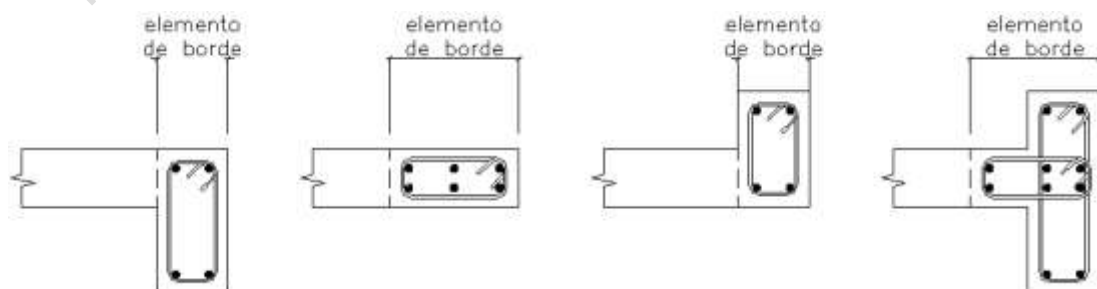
Ejemplos de elementos de borde en diafragmas estructurales
